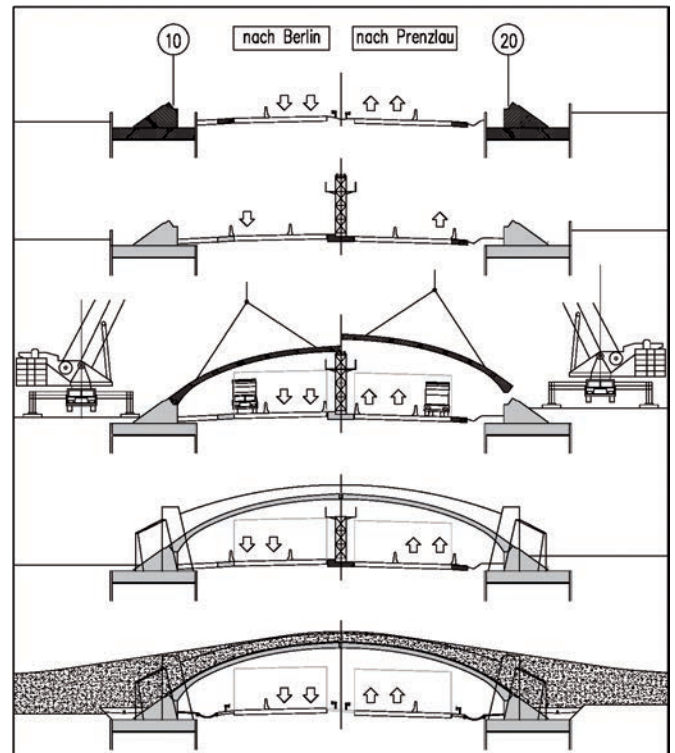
Geplanter Bauablauf mit Verkehrsführung
